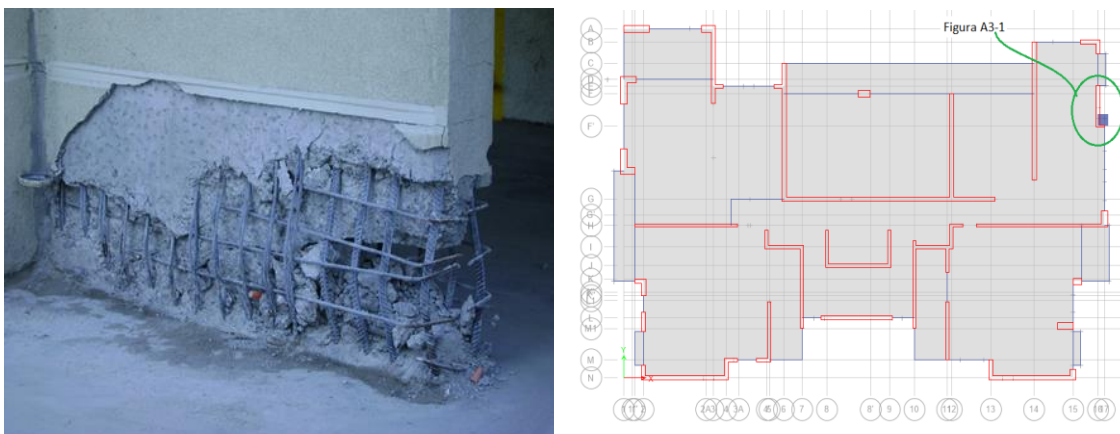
Imagen del daño y ubicación en planta del elemento A3-1
